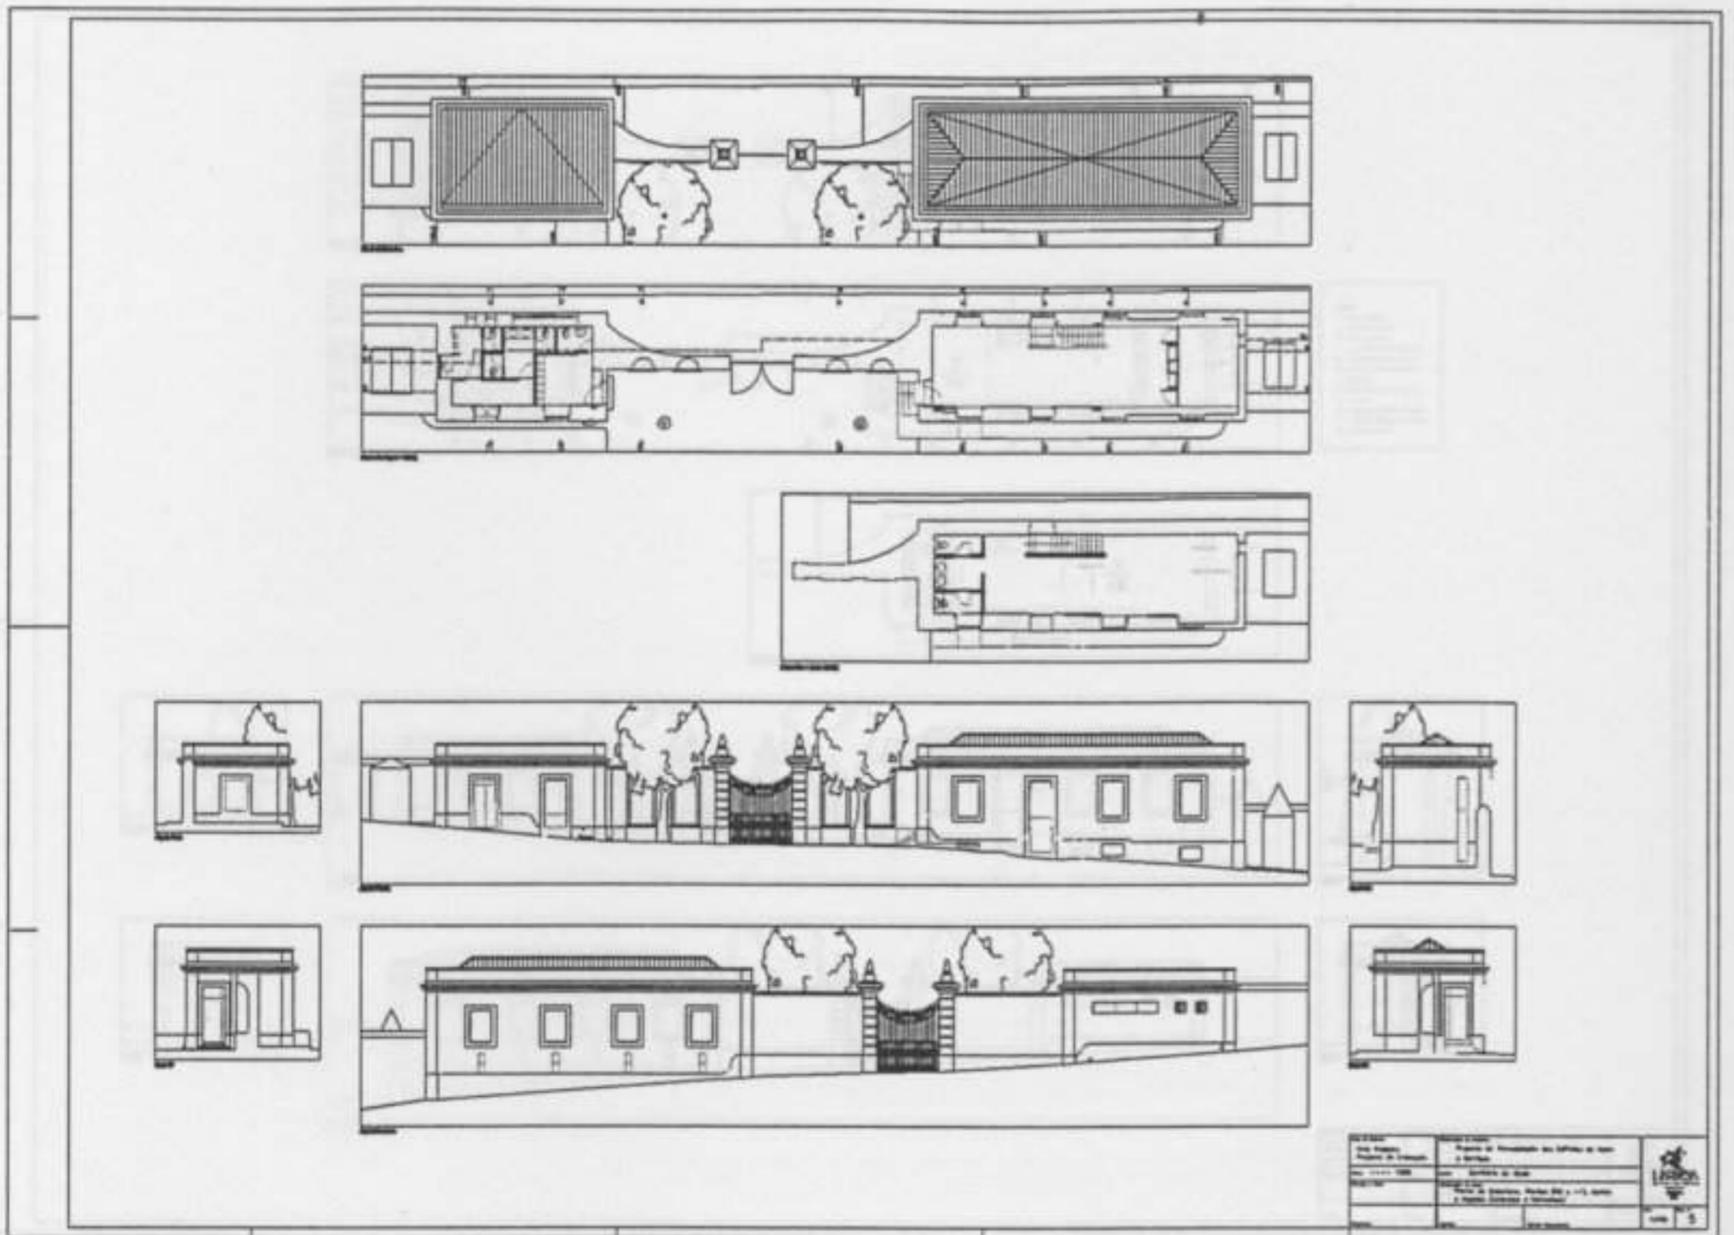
Ante-Projecto - Planta de Cobertura, Plantas e Alçados - Amarelos e Vermelhos - Esc. 1/100 - Des. nº 5.
